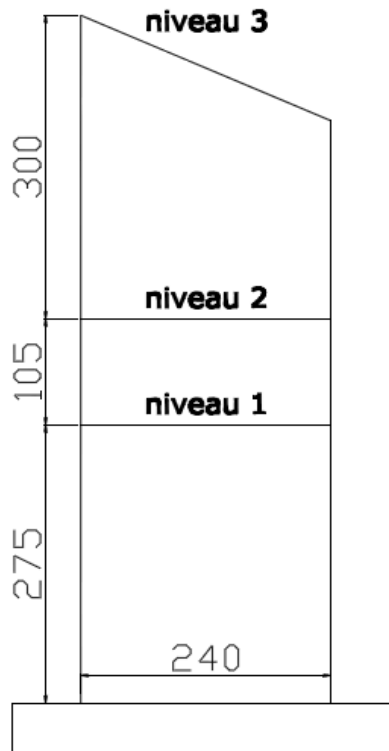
Schéma du voile à ferrailer (dimensions en cm)
